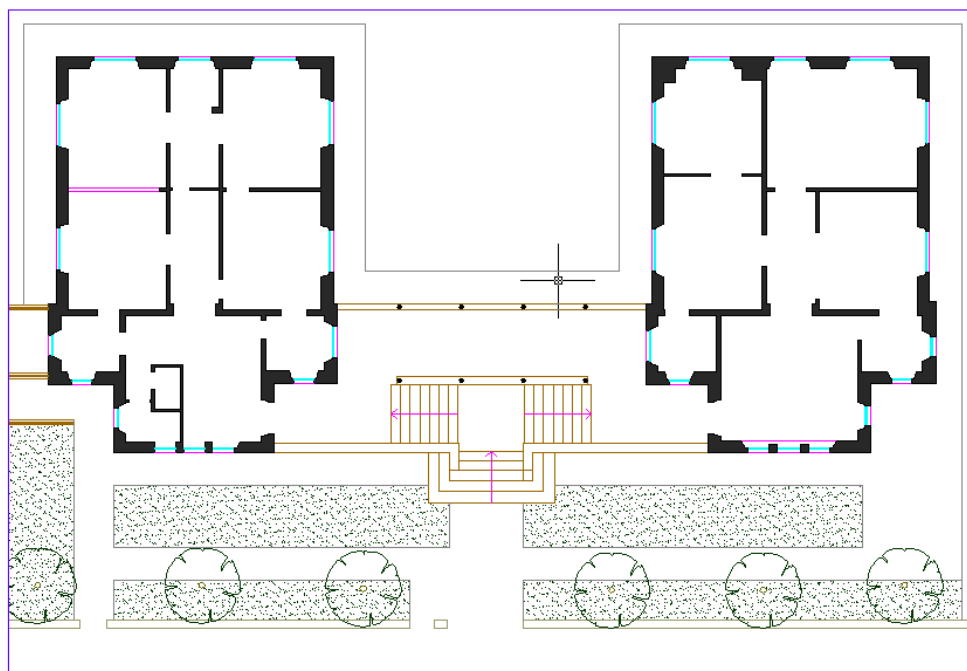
Planimetria stato attuale – PIANO TERRENO RIALZATO
